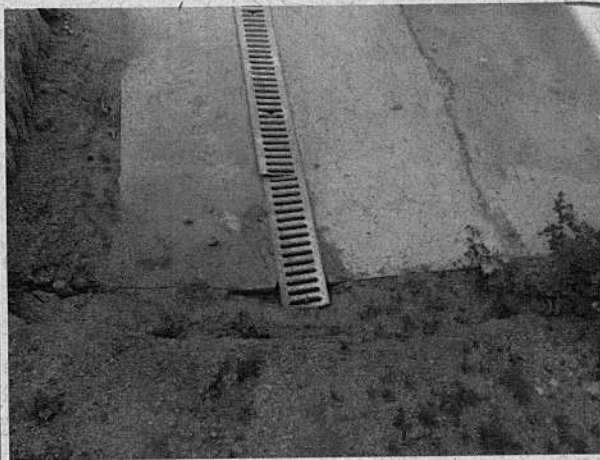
, 24-08-16: Traslado de empalme eléctrico, plano TGA-001-00-PL-001-A.
